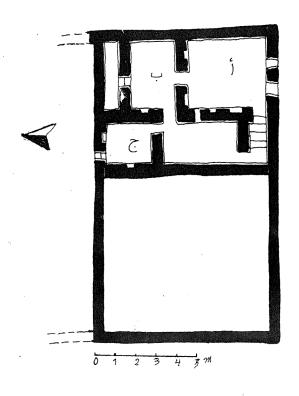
منزل ابو همام الواجهة – مسقط رأسي
